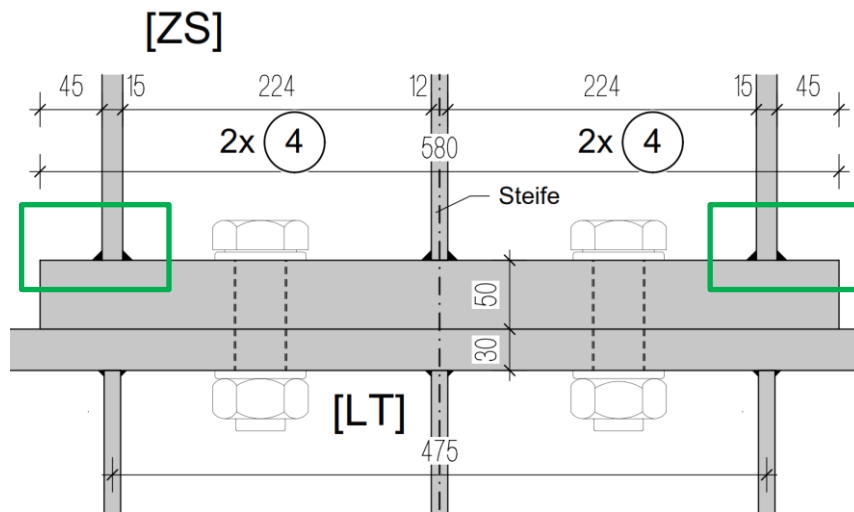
Ansicht der Schweißnähte Endplatte LD_{ULS}05
